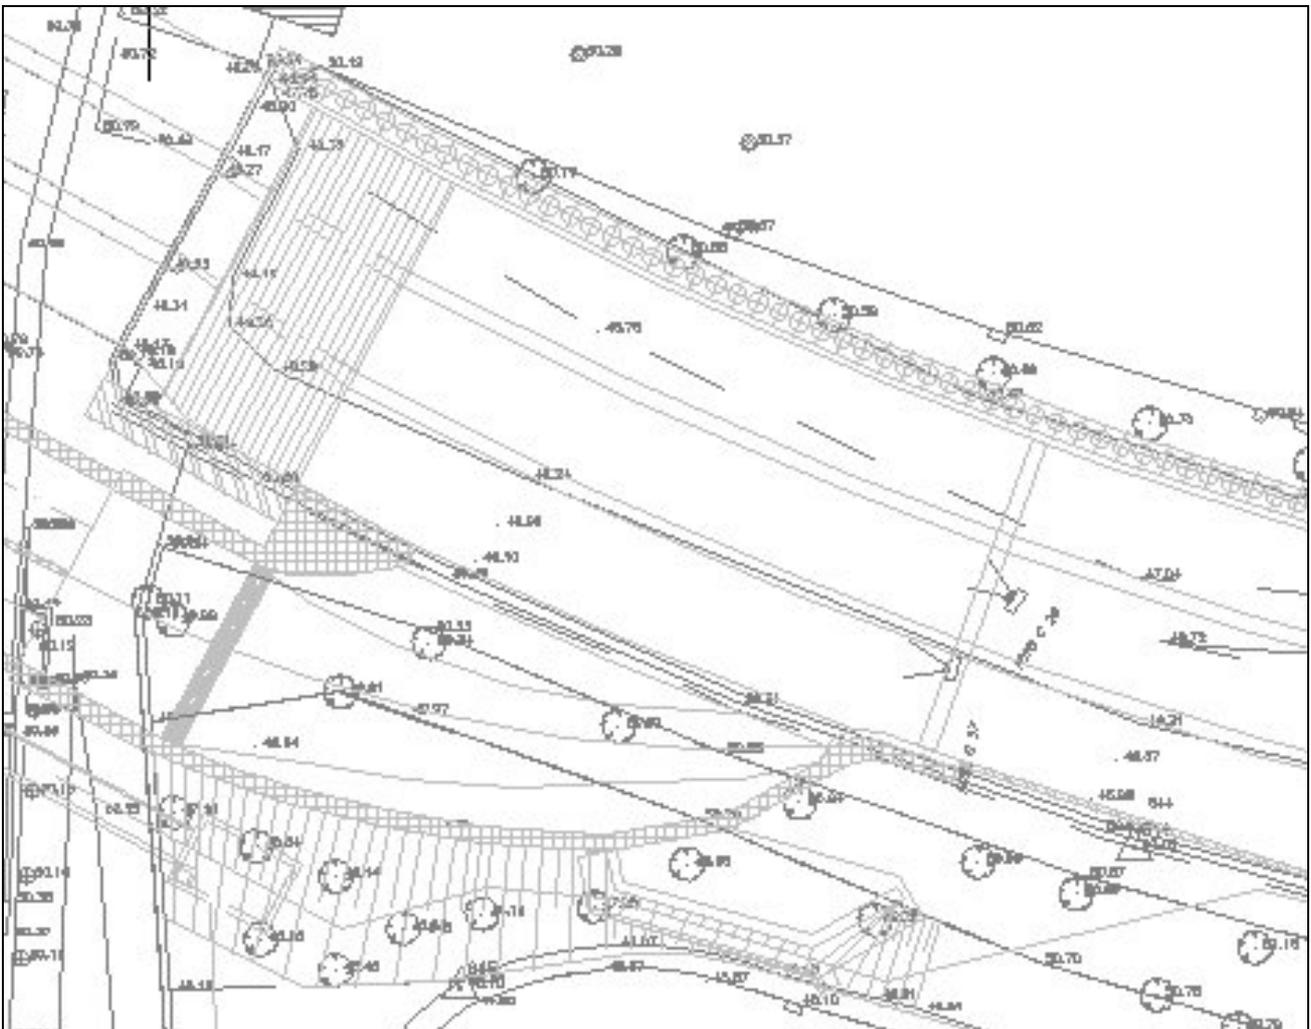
Planimetria di progetto presso la zona di imbocco al bypass.
